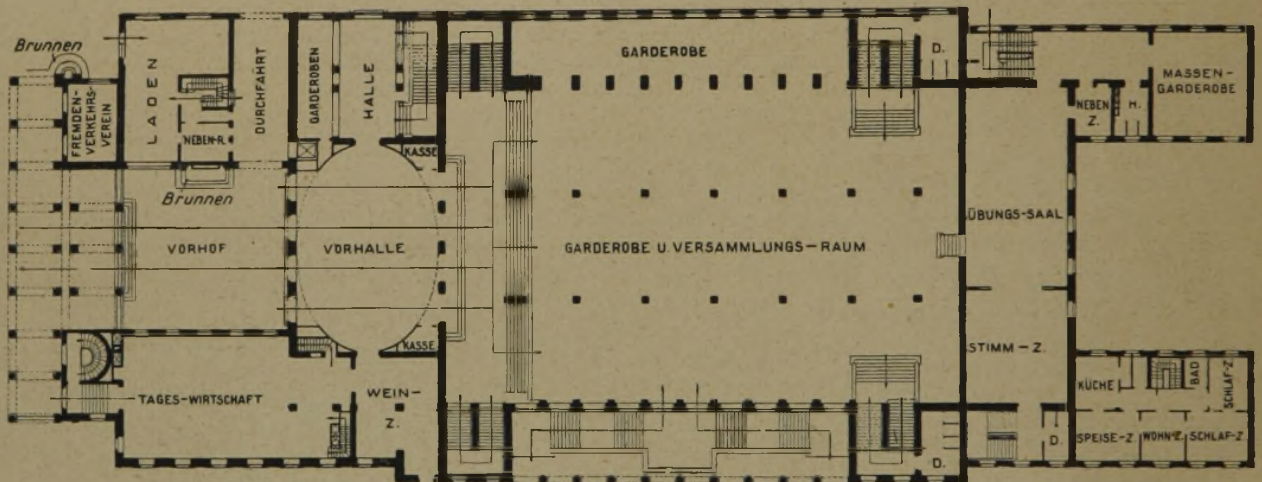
Grundriß. Untergeschoß (rd. 1 : 600).
